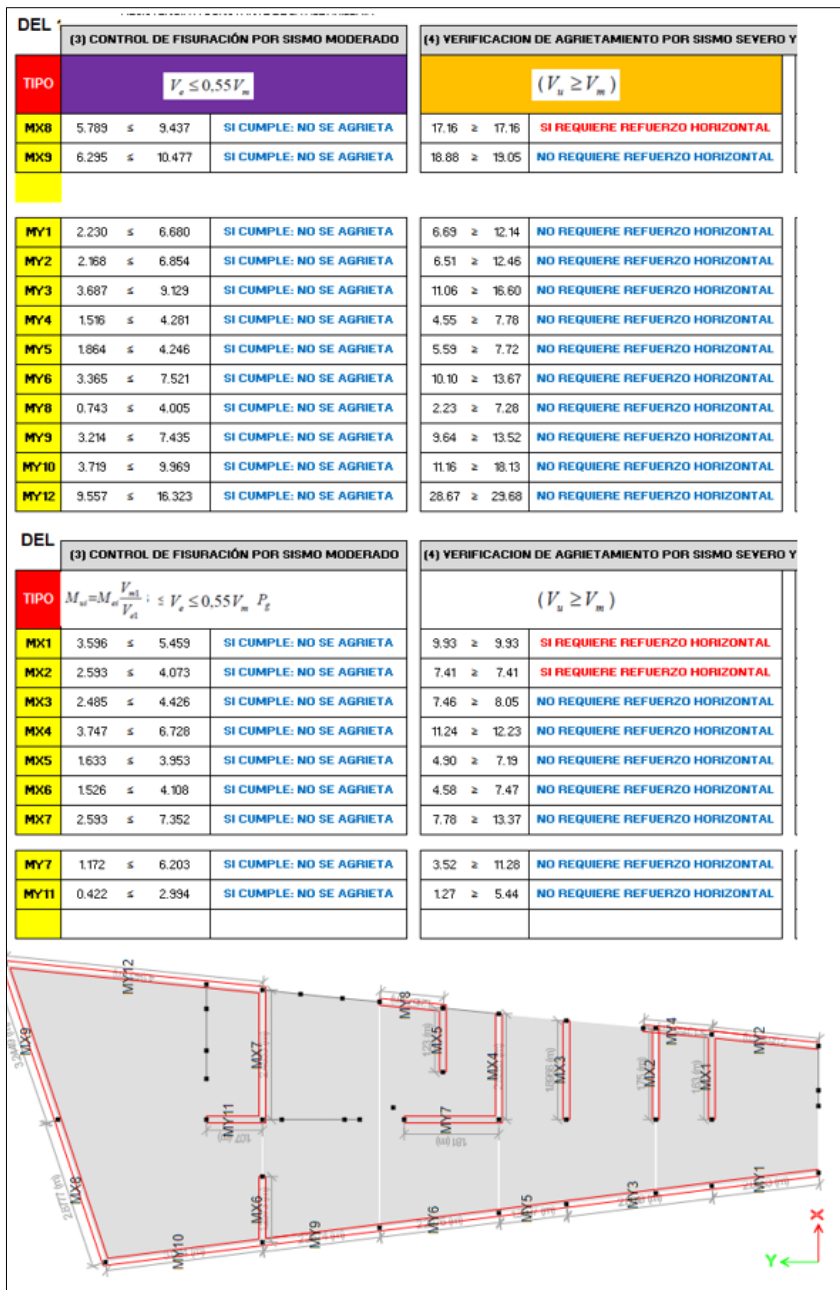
Control de fisuración por sismo severo y moderado de la vivienda 05
